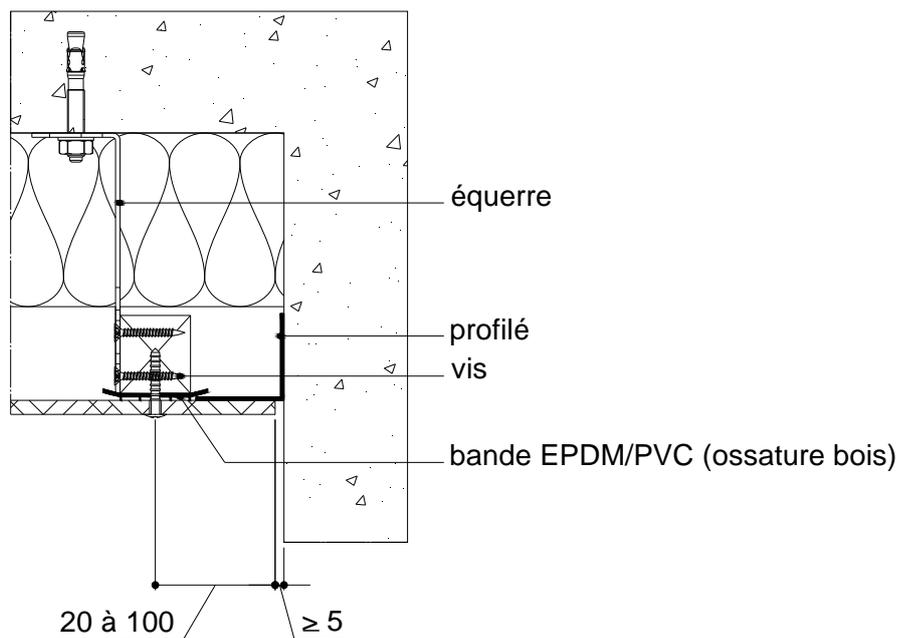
Détail connexion contre un mur sans bardage (coupe horizontale) sur ossature bois ou métallique (cote en mm)
